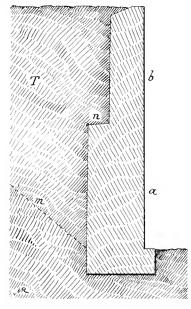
Coupe verticale d'un mur de souténement a redan.
